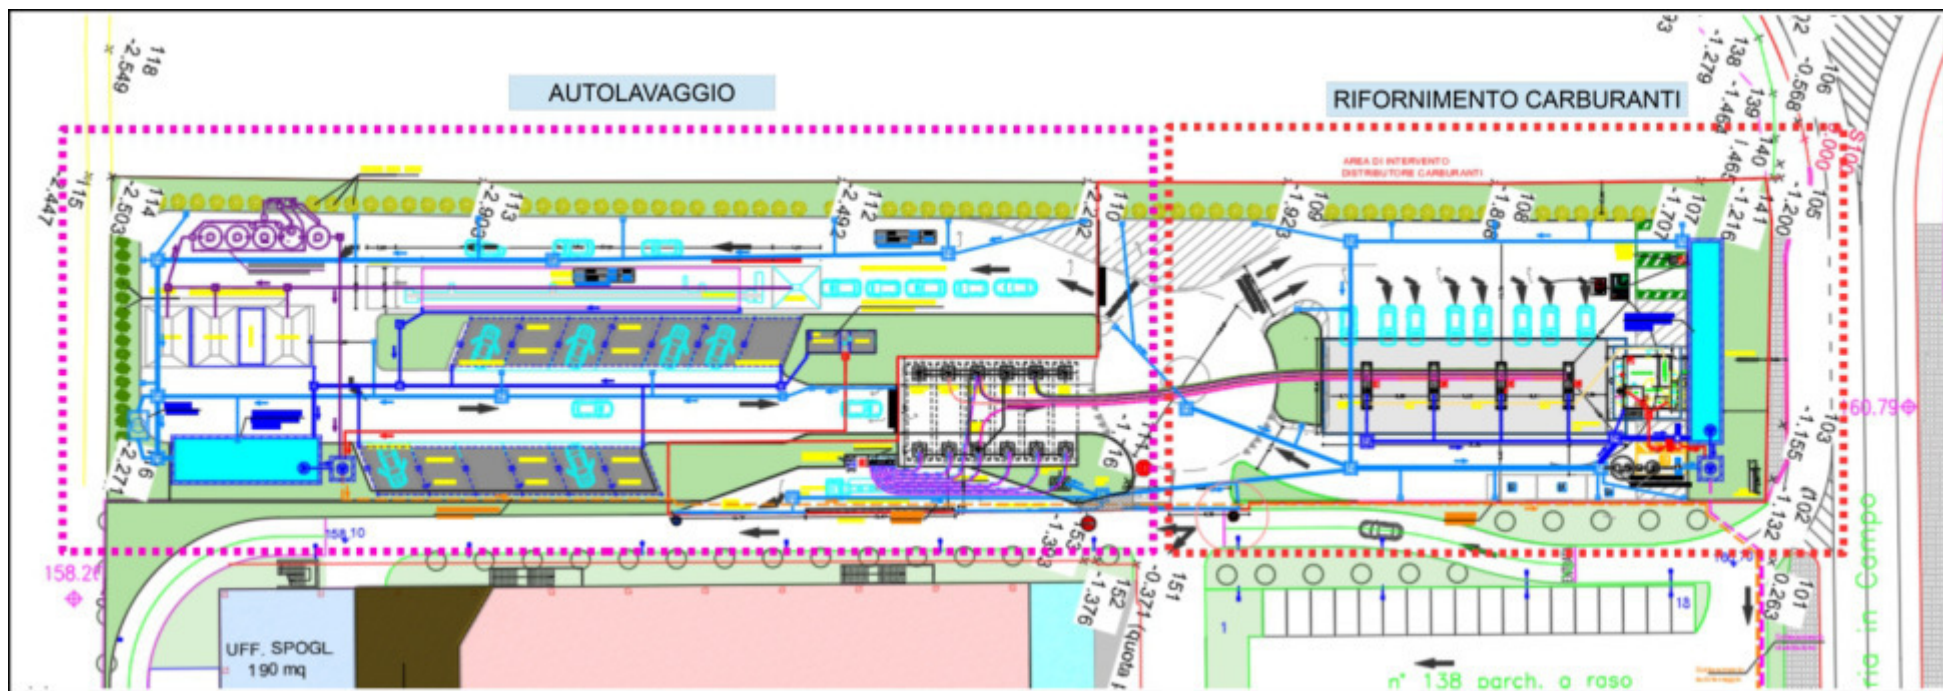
Estratto Planimetria generale dello stato di fatto.
